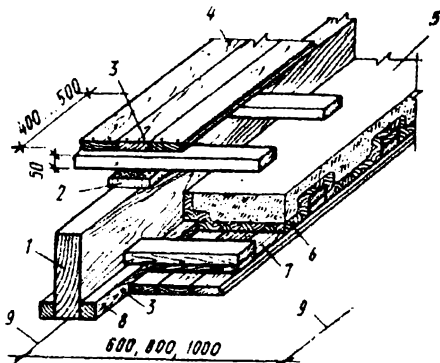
Деревянные перекрытия по брусковым балкам с квадратными черепными брусками
